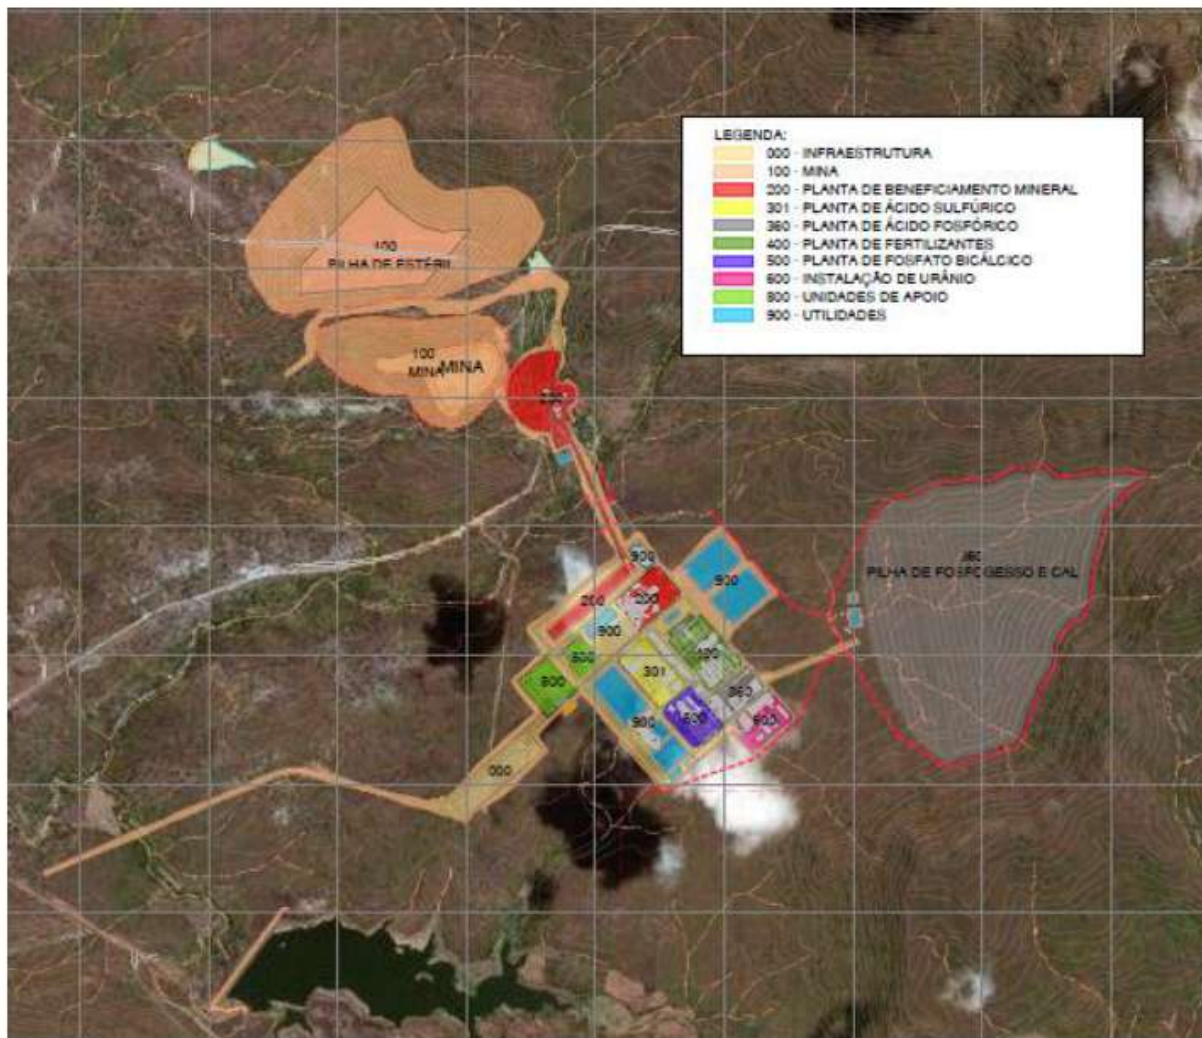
Arranjo geral do Projeto Santa Quitéria
